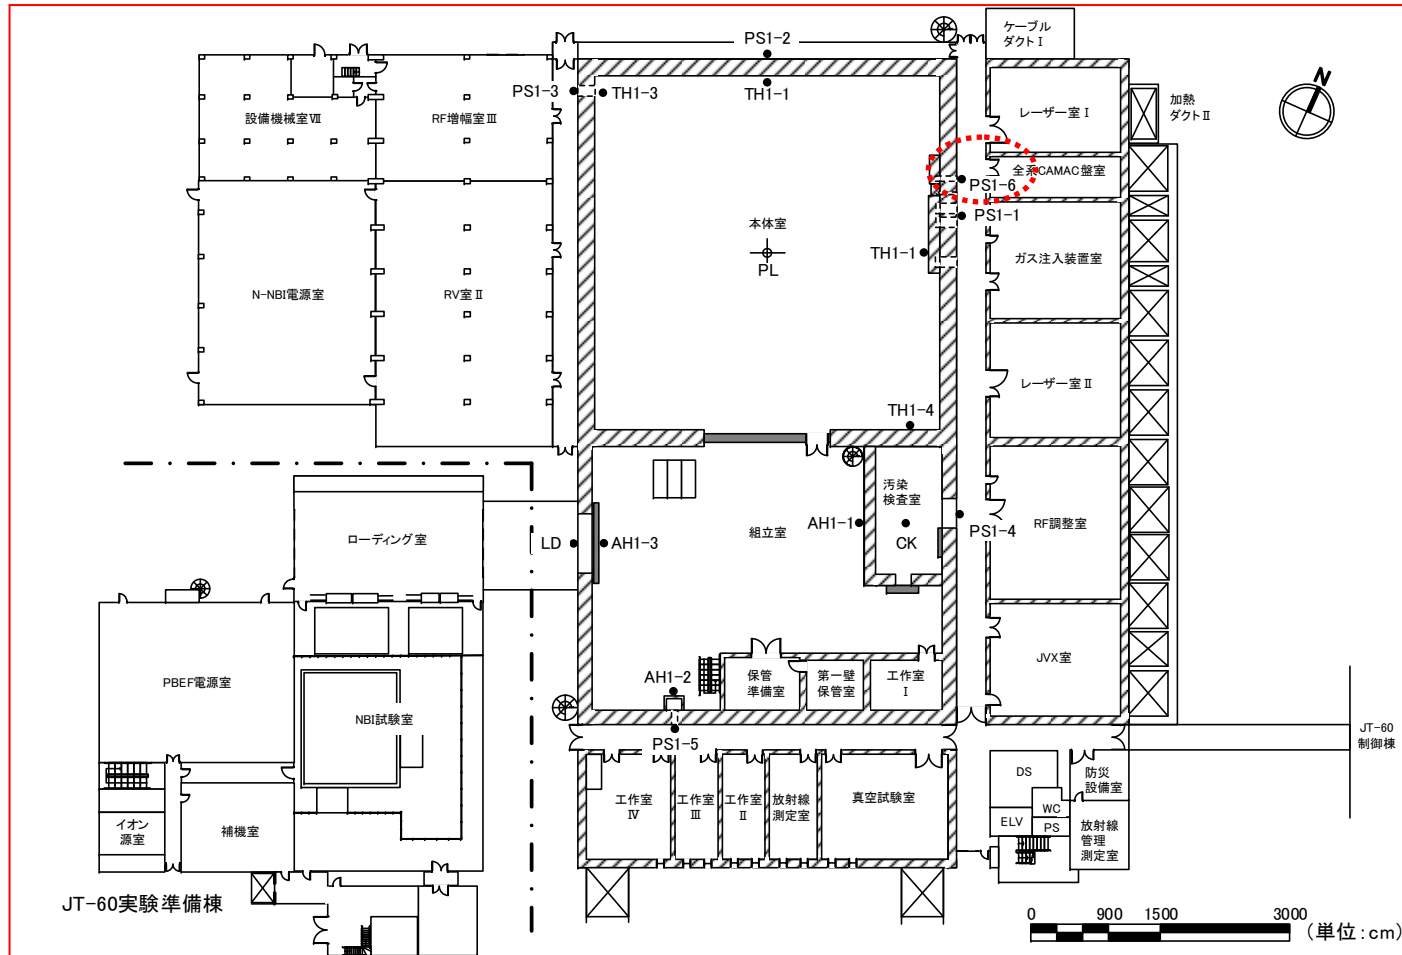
1. 5. 1 JT-60実験棟1階平面図 (単位: cm) (改修後)
